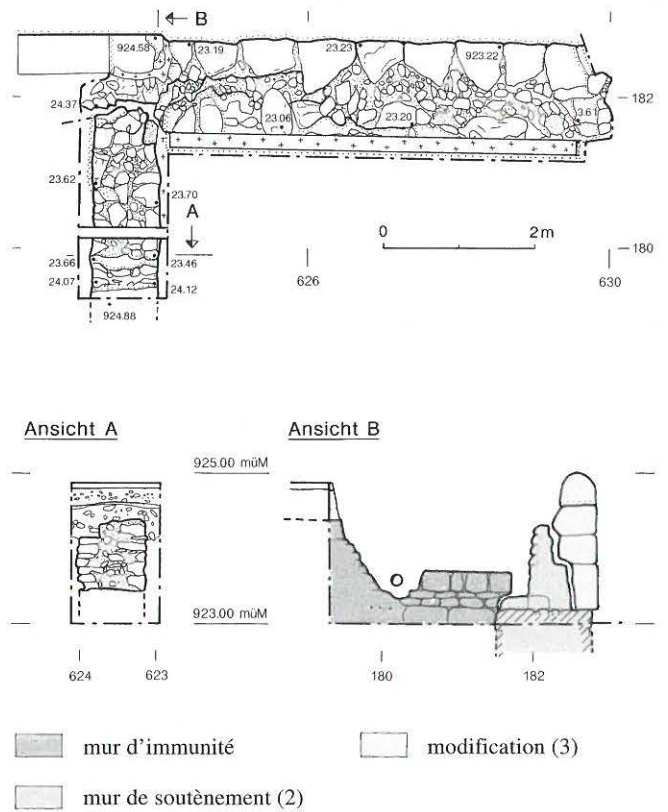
Saicourt, Bellelay, mur de soutènement sud. Extrait avec plan et vues des points de recoupement des anciens murs. Echelle 1:100.
